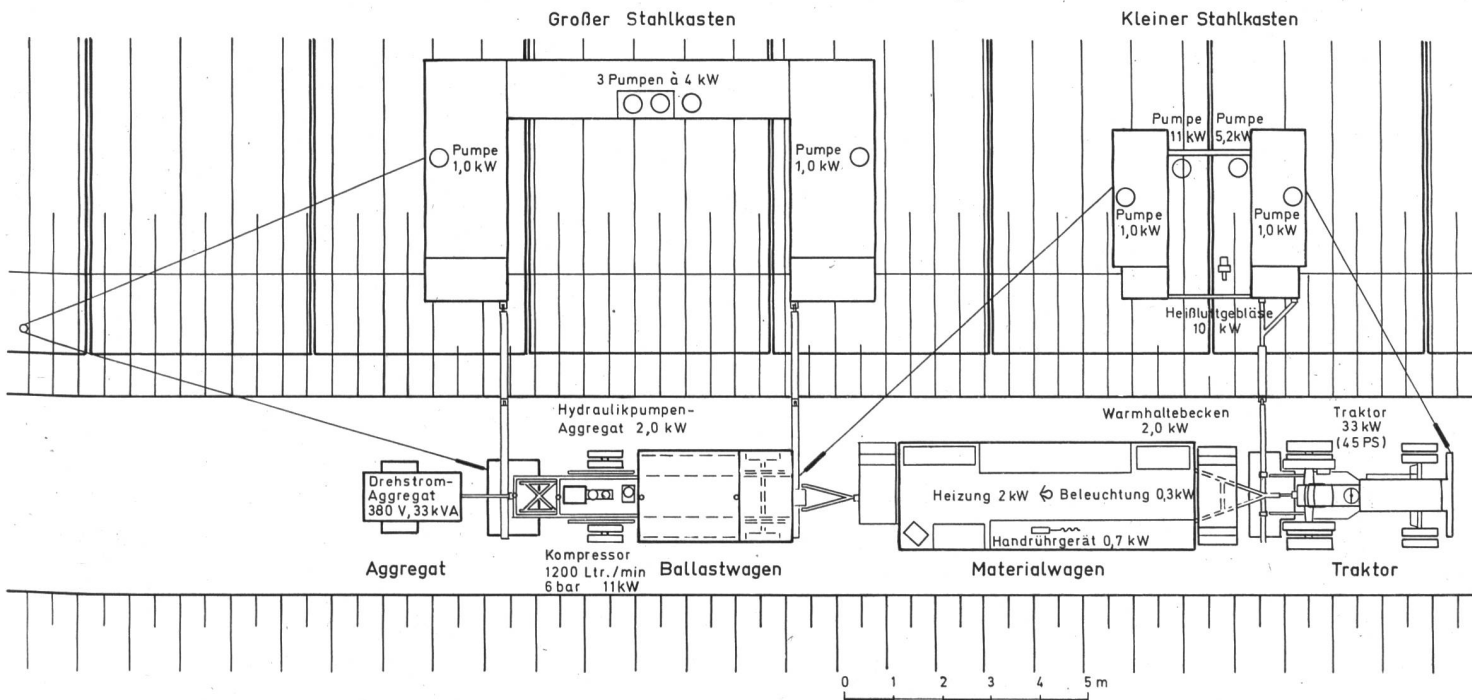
Grundriss der Bauinstallationen zur Sanierung der Betonplatten.
